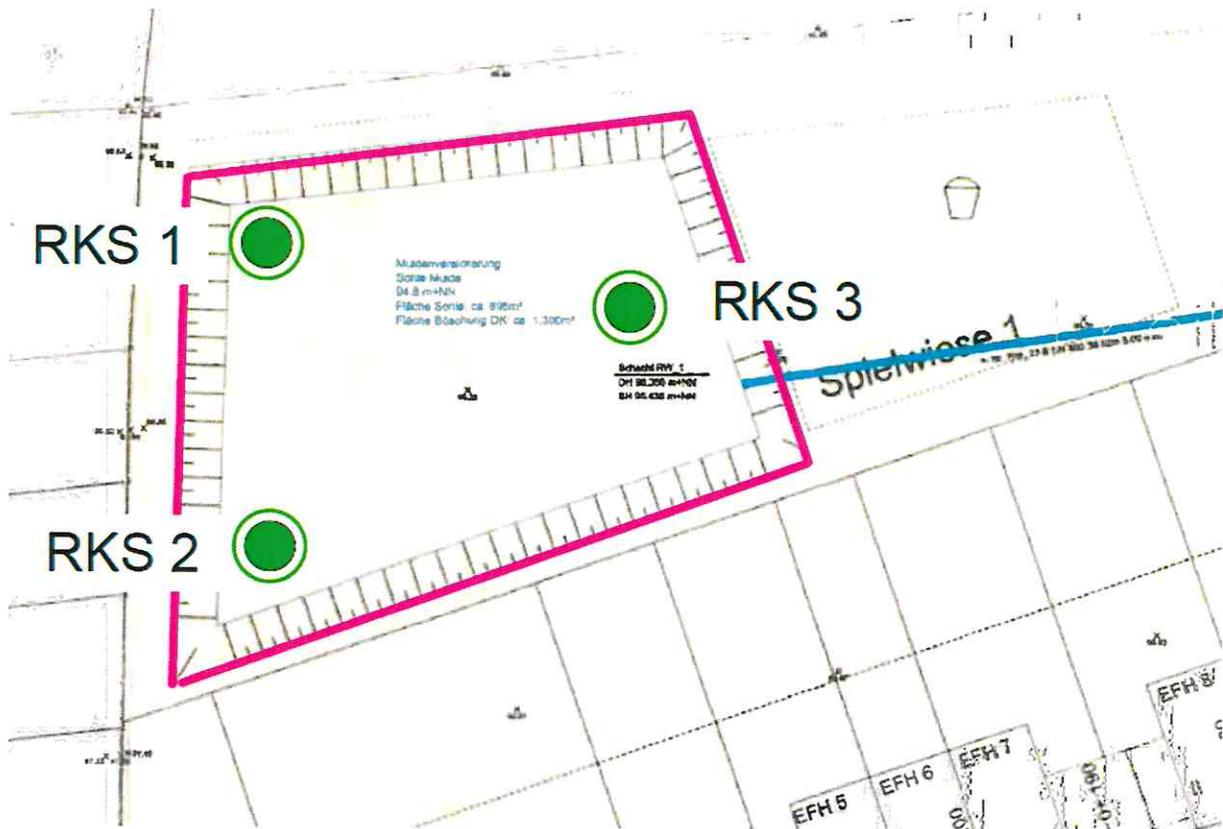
Lageplan mit Eintragung der Prüfstellen
